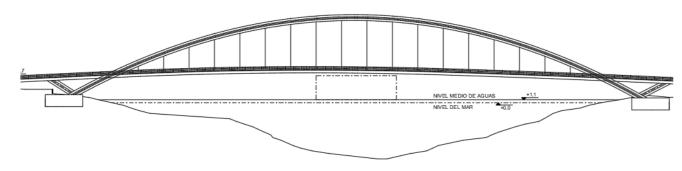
Alzado de la solución adoptada (Fuente: Propia)
